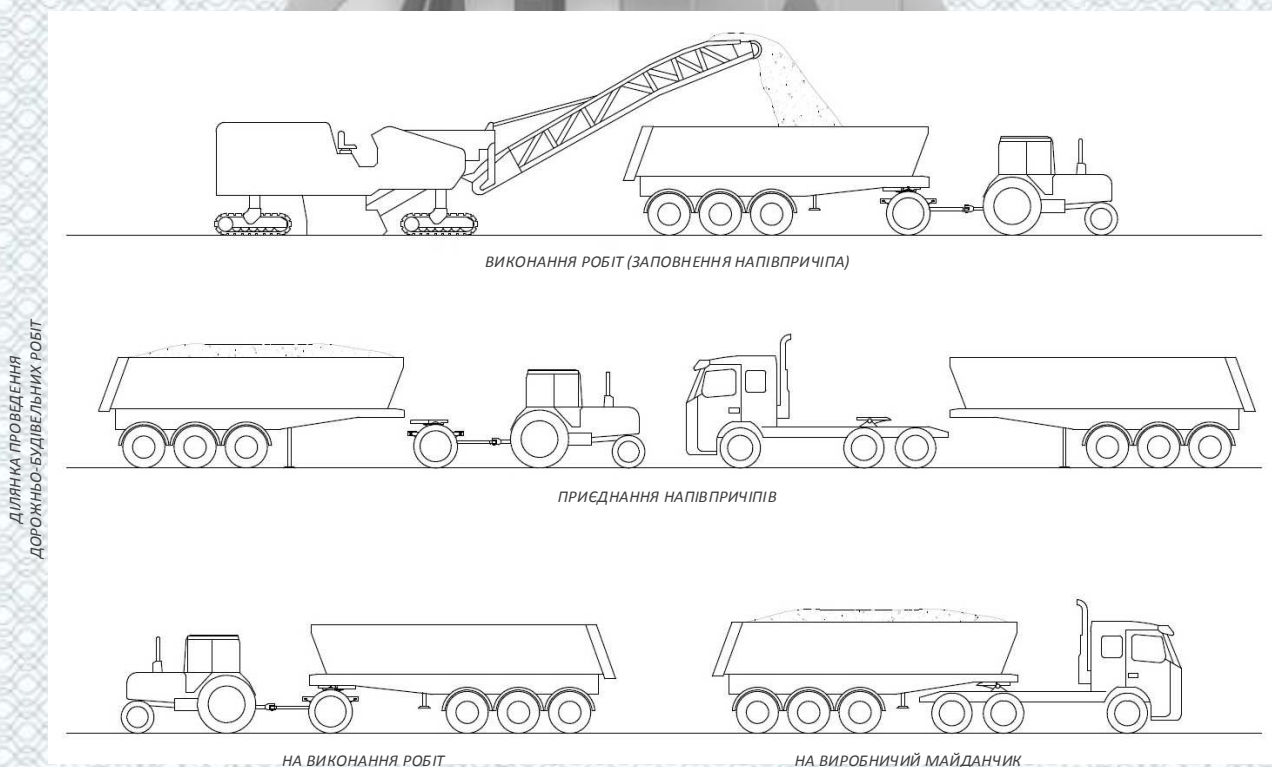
Схема перевезення по методу оборотного напівпричепа при фрезерування дорожнього покриття
